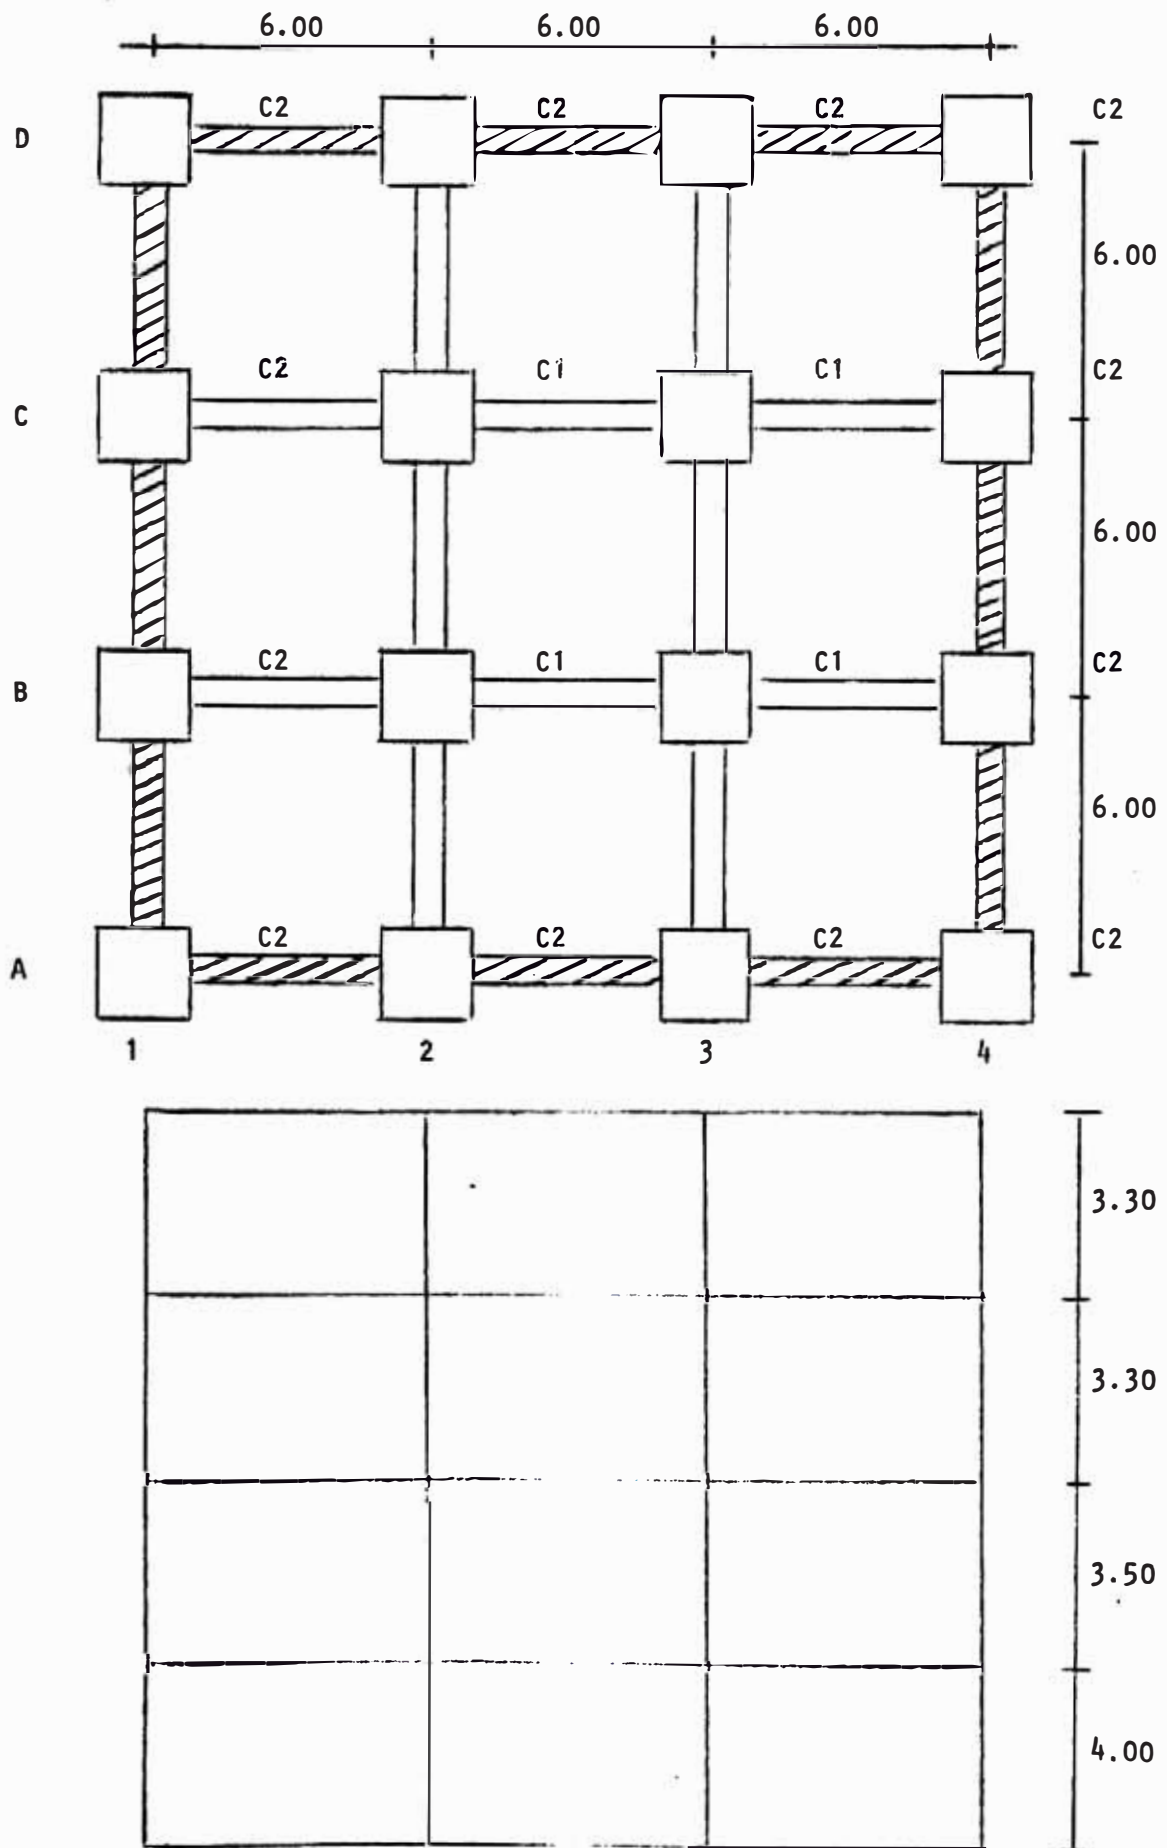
PLANTA TIPICA Y ELEVACION
